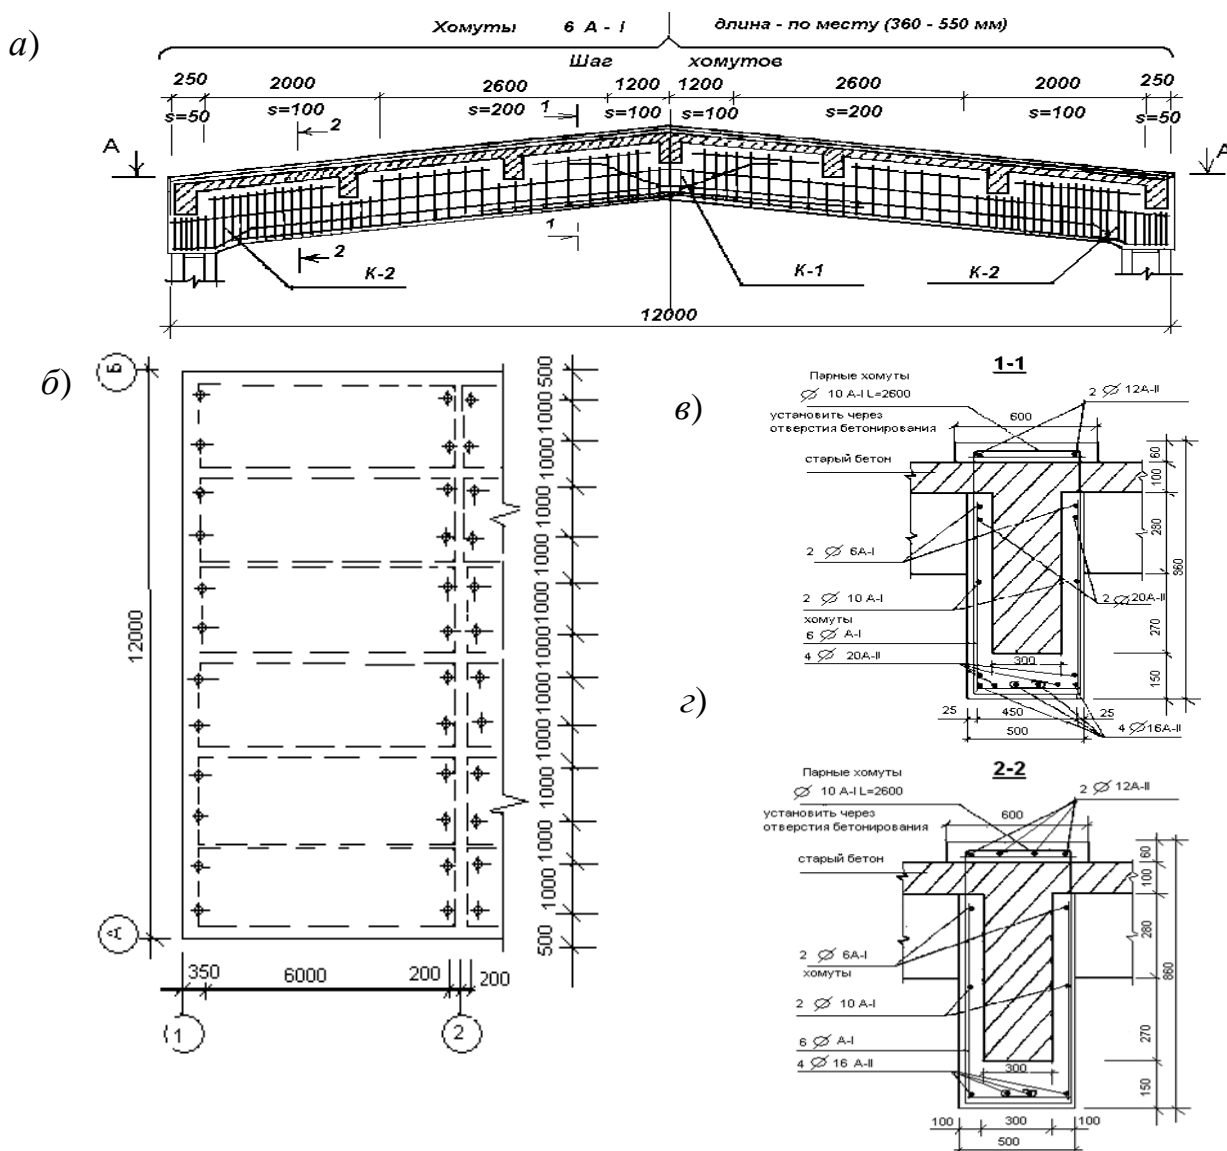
а – схема усиления ригеля поперечной рамы здания; б – схема расположения отверстий для бетонирования усиления ригеля; в – разрез по 1-1; г – разрез по 2-2
